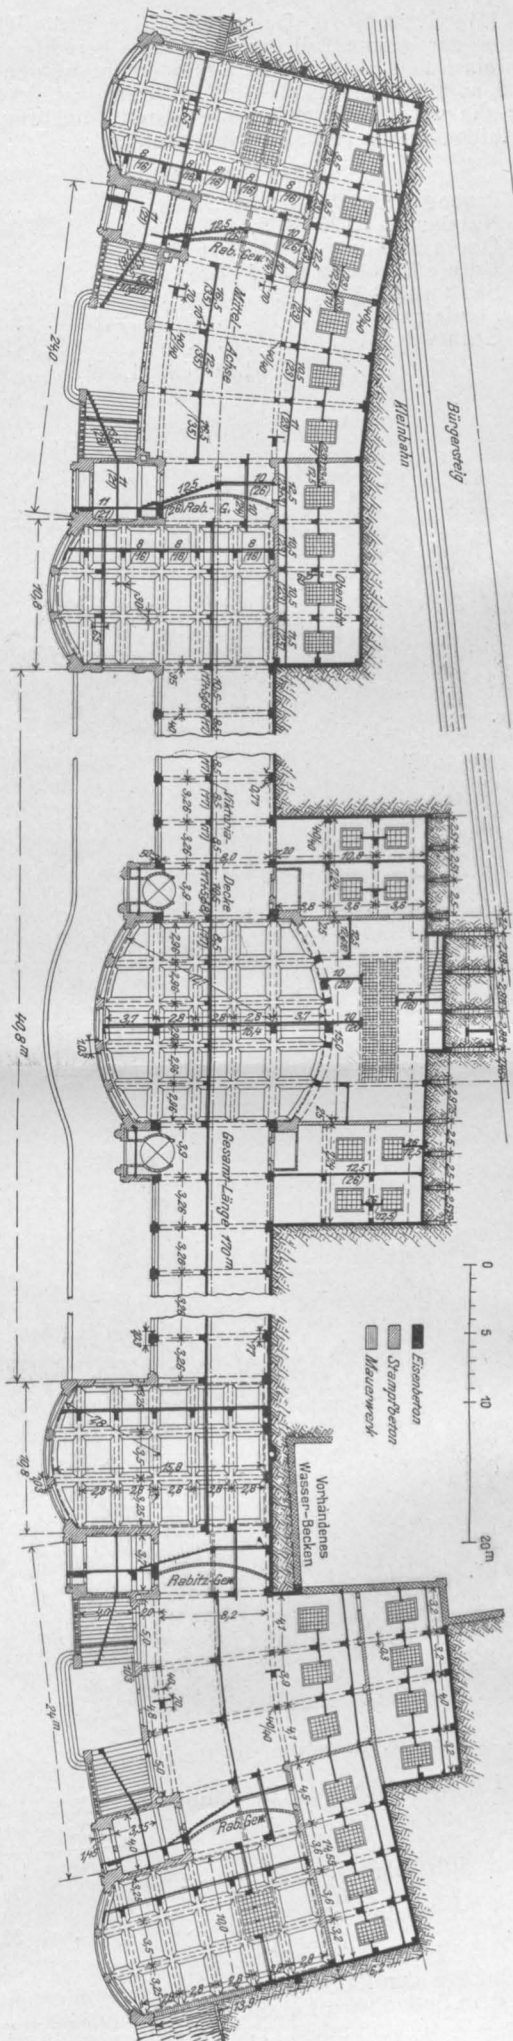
Grundriß der Halle mit Eintragung der Decken-Schnitte.
